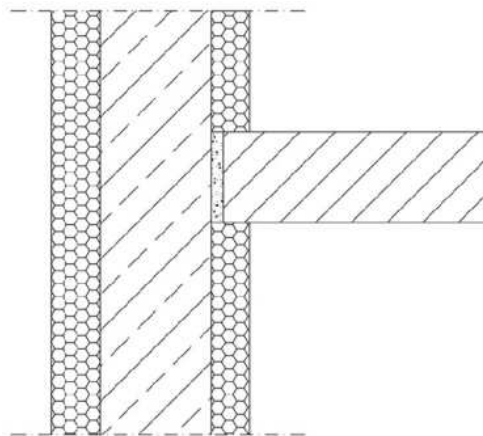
Vista em planta da ligação com parede não estrutural com remoção de isolamento térmico (ARGISOL, 2010).
